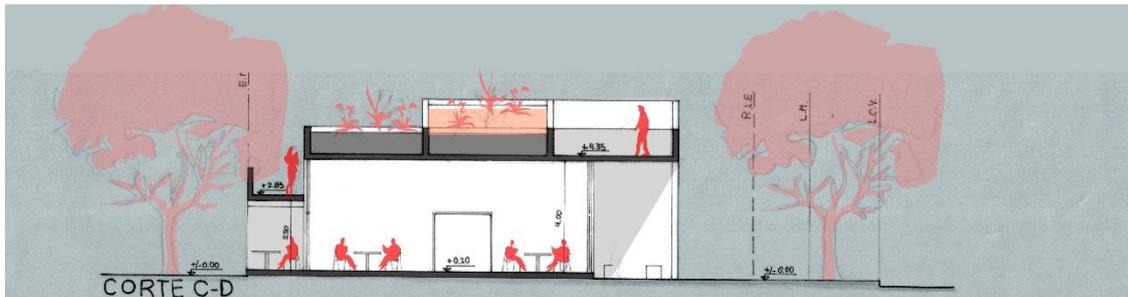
La inversión de los pórticos con losas colgadas, permite cubrir libremente espacios de distinto calibre y diversa modulación sin la interferencia de vigas en el cielorraso de planta baja. En el plano de cubierta, estos elementos constructivos se transforman en canchales y barandas, posibilitando su apropiación.
